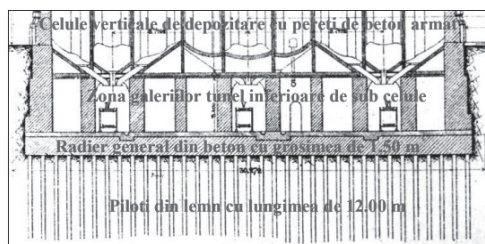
Elementele structurale de la baza silozului. Zonele fundației și a galeriilor inferioare longitudinale de sub celulele verticale de depozitare a cerealelor [15].
